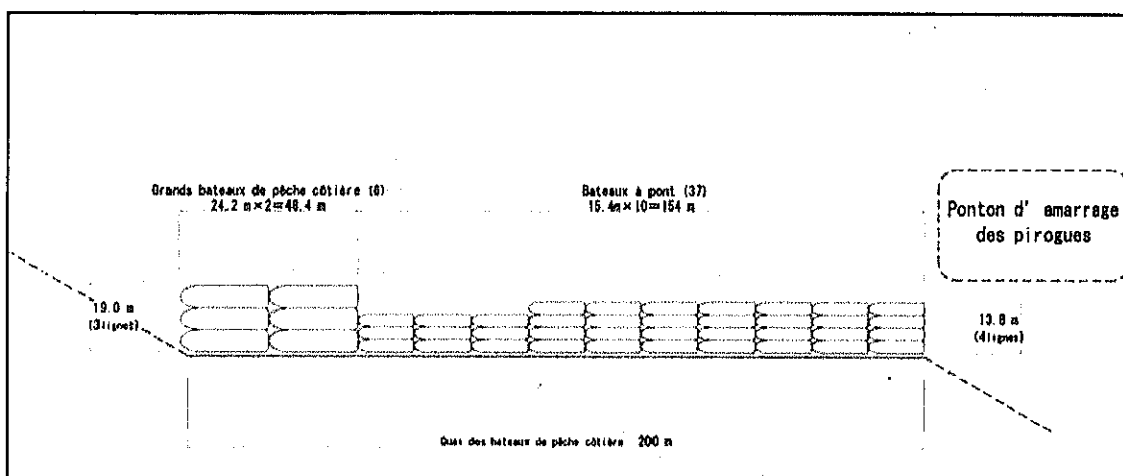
(5) Plan conceptuel de disposition d'amarrage sur le quai
